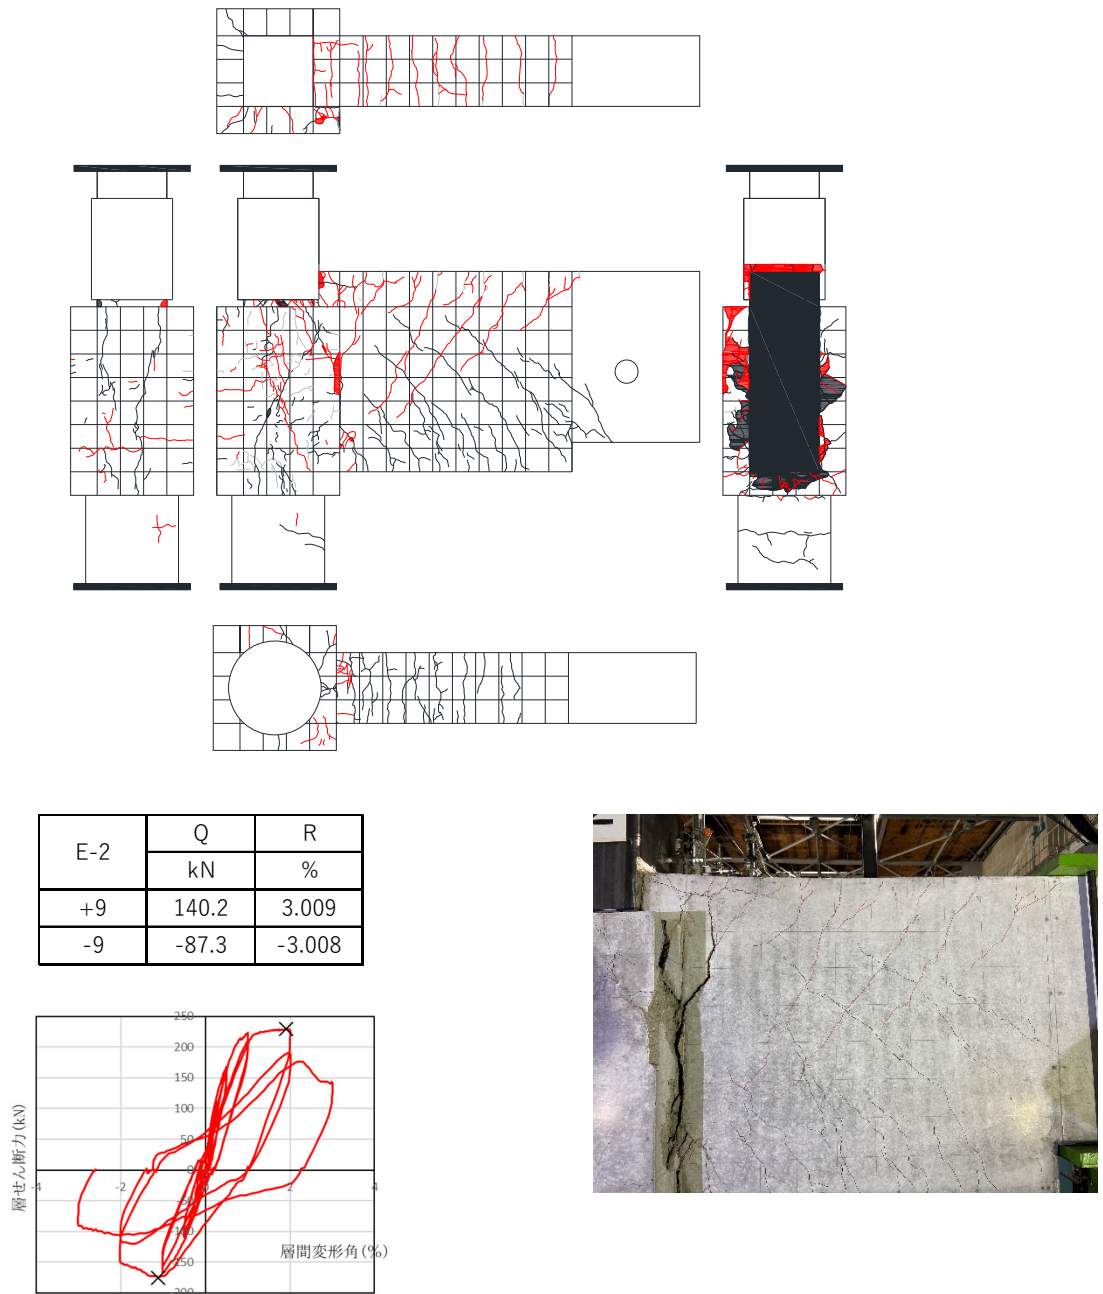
E-2 ひび割れ状況 (6Cycle)
